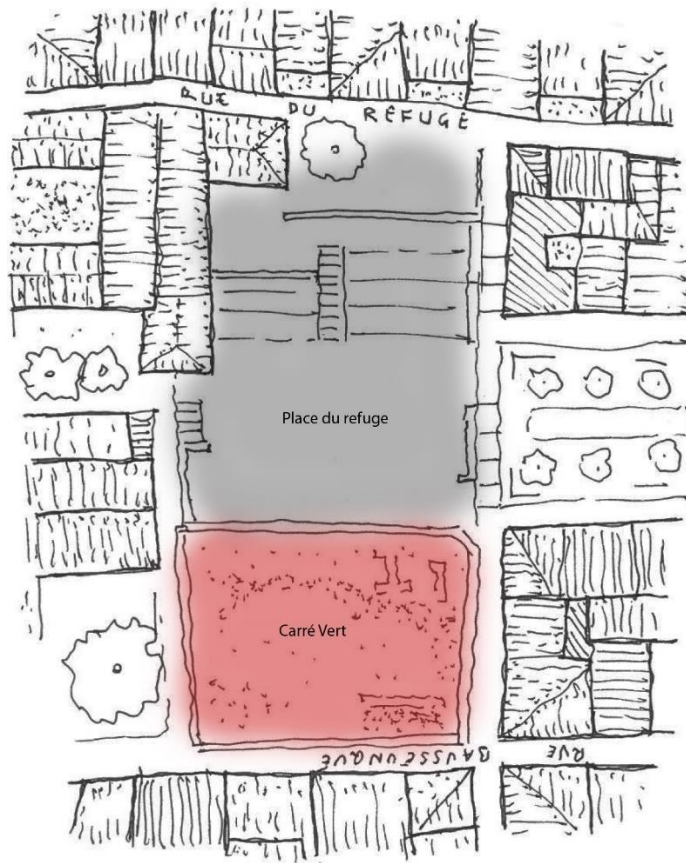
Plan du Carré Vert et de la place du refuge, fait par M. Serre
